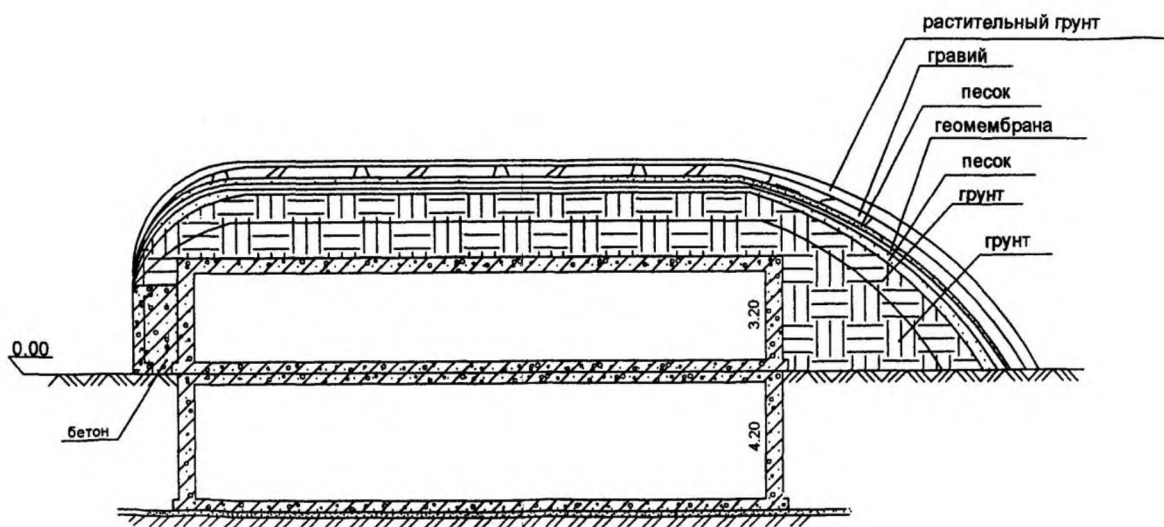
Устройство усиленного защитного покрытия двухъярусных хранилищ РАО
